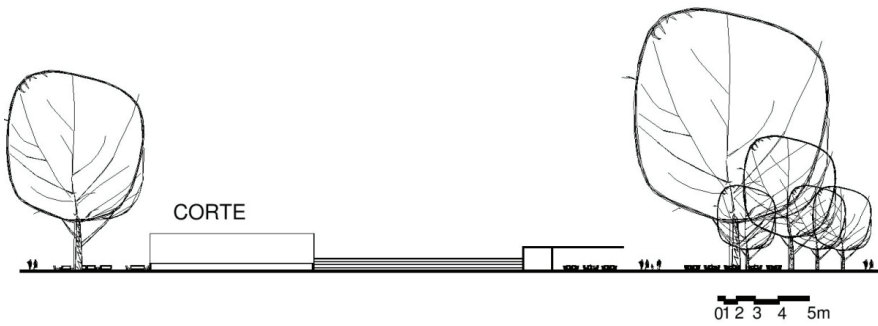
Corte do projeto de intervenção da Praça Primeiro de Maio
